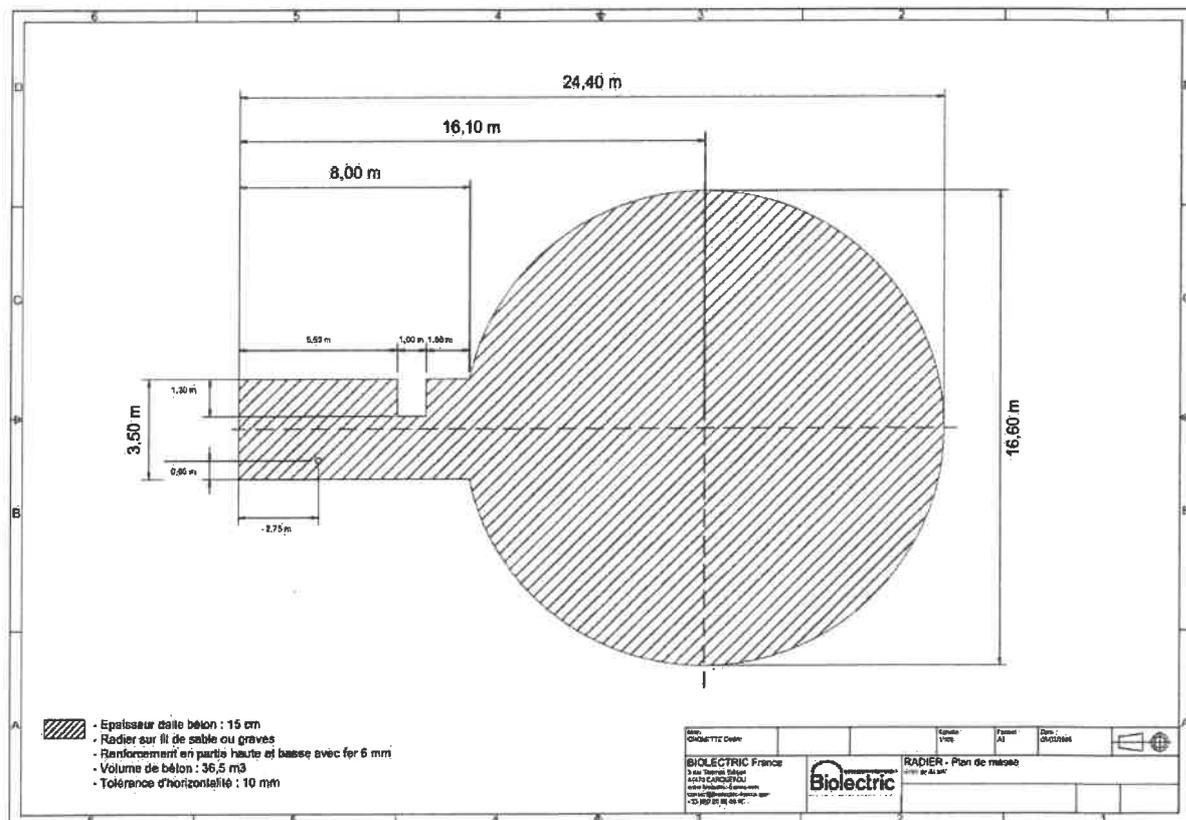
Radier béton de support des ouvrages (voir plan au format A3 en fin de document)
